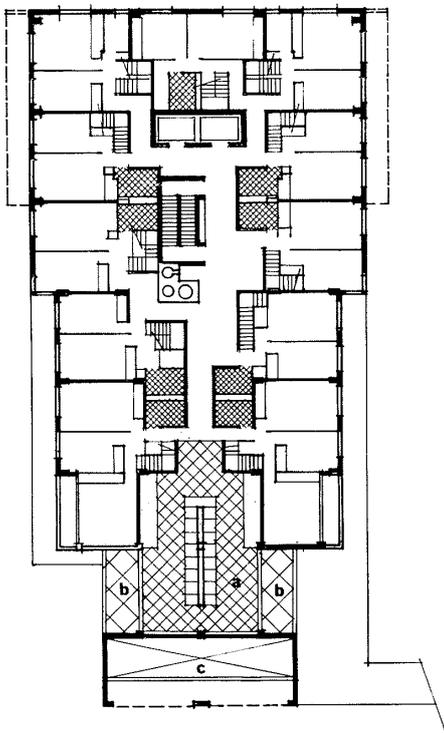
Brighton Beach Housing. 3º pavimento
